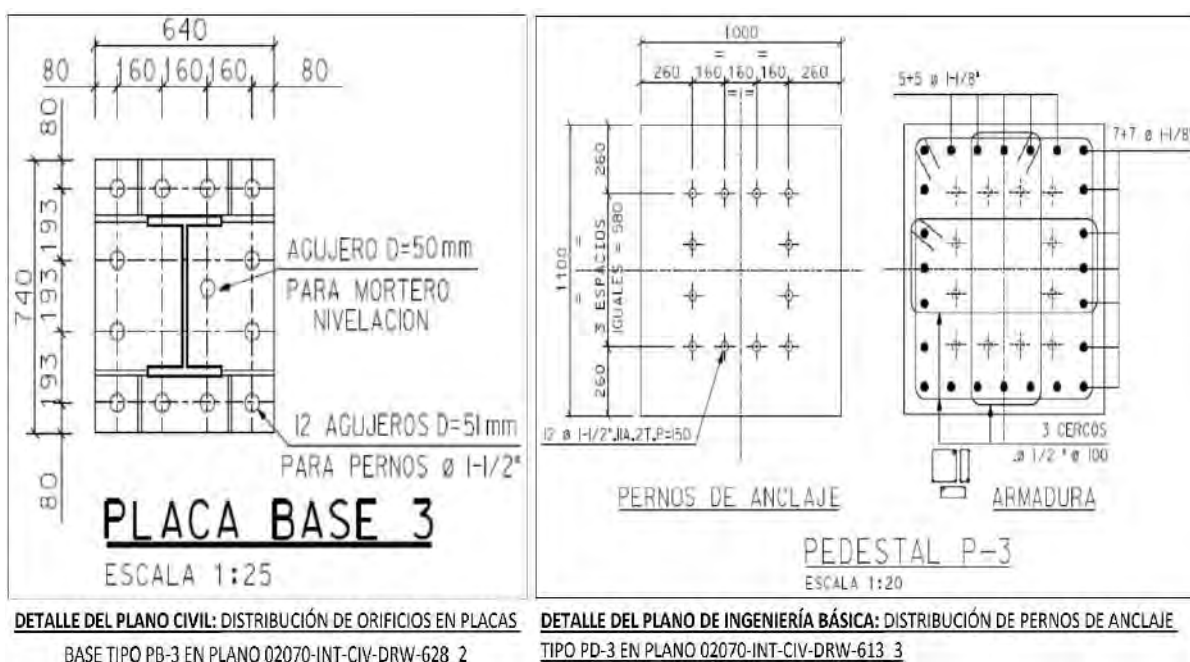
Plano civil y de ingeniería básica de pernos de anclaje en cimentaciones
